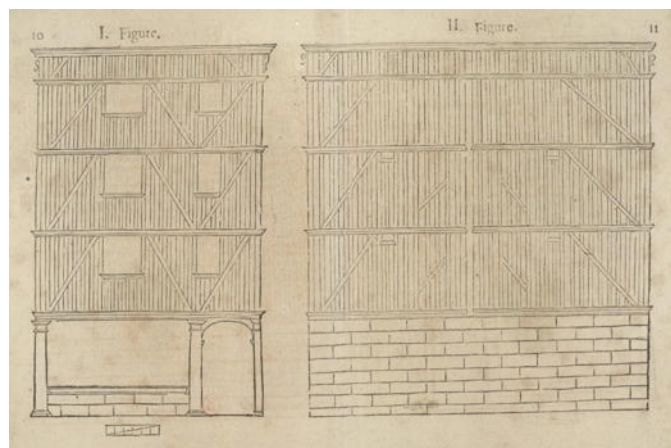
Planche figurant les murs (pignon et gouttereau) d'une maison à pan de bois à grille
